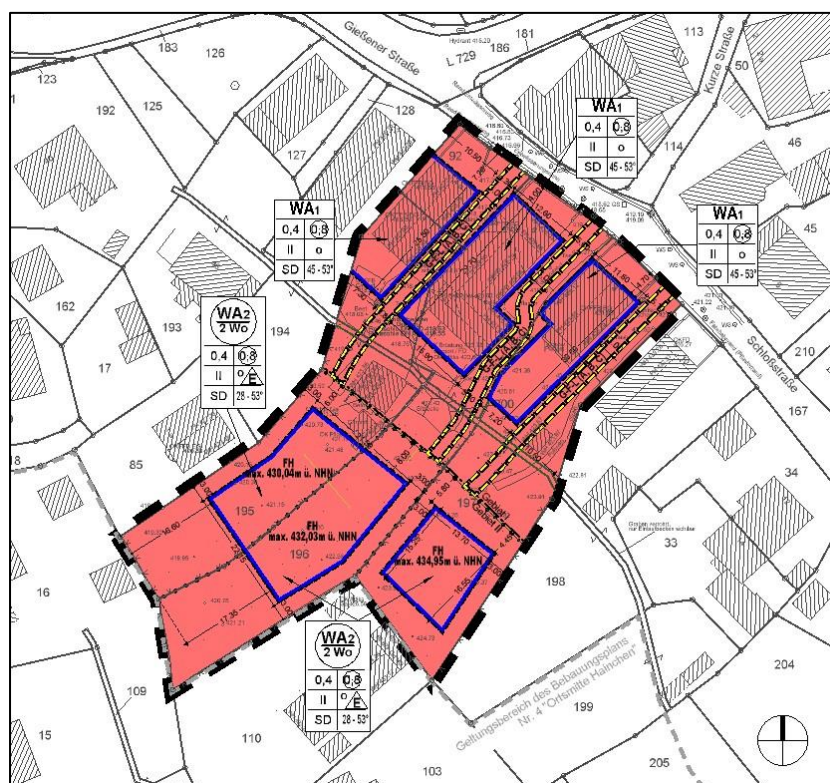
Übersicht Planung/Entwurf (Quelle: Planzeichnung /Ausschnitt verkleinert)
